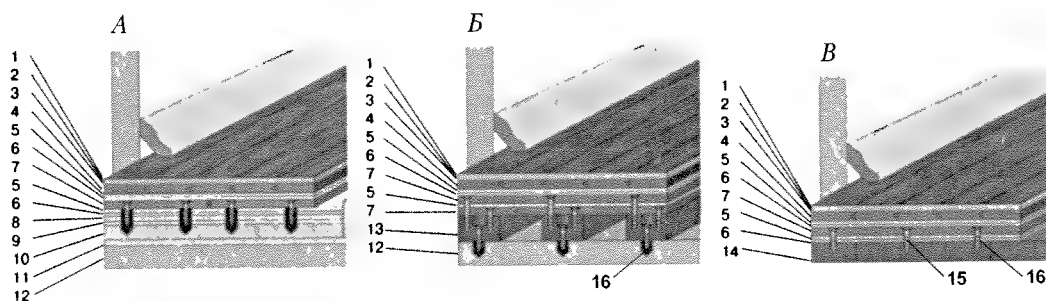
Схема конструктивного решения пола с покрытием из штучного паркета, разработанная фирмой «Паркет Холл»: А — на бетонном перекрытии (со стяжкой); Б — по лагам; В — по черновому или старому деревянному полу; 1 — лак 2–3 слоя; 2 — лак-грунтовка; 3 — шпаклевка под лак; 4 — паркет; 5 — паркетный клей; 6 — грунтовка под клей; 7 — влагостойкая фанера; 8 — жидкая шпаклевка; 9 — эмульсия-грунт под шпаклевку; 10 — стяжка; 11 — гидроизоляция; 12 — бетонное перекрытие; 13 — лаги; 14 — черновой или старый деревянный пол; 15 — дюбель-гвоздь; 16 — дюбель
